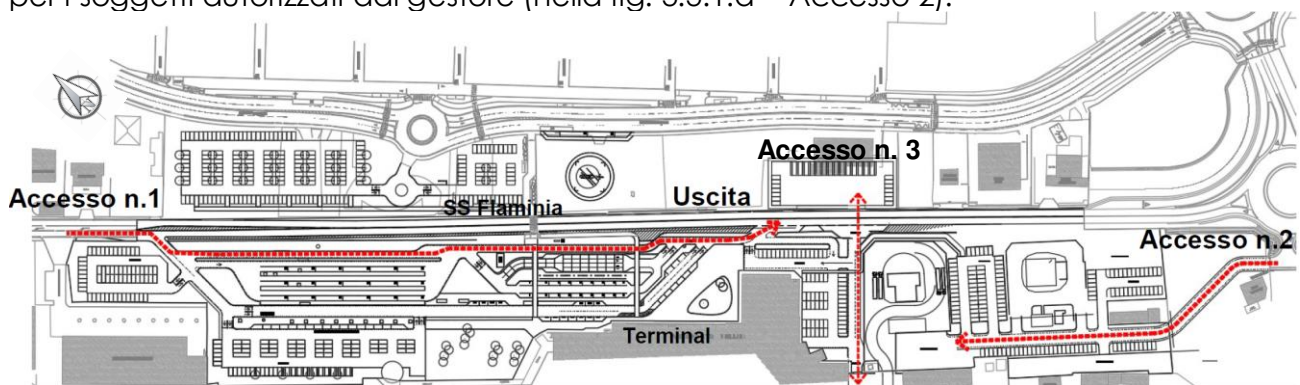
a – riorganizzazione degli accessi e delle uscite di progetto
